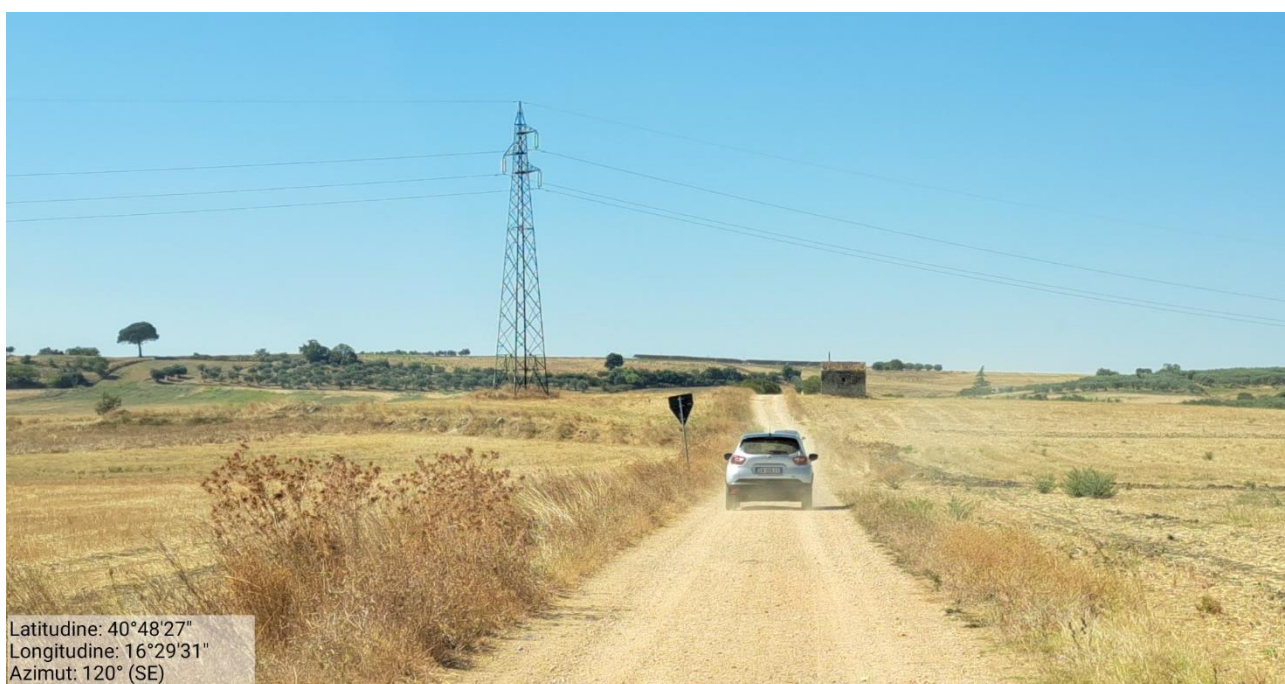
Tracciato rurale esistente da adeguare di accesso alla postazione eolica S2 (direzione sud-ovest).
